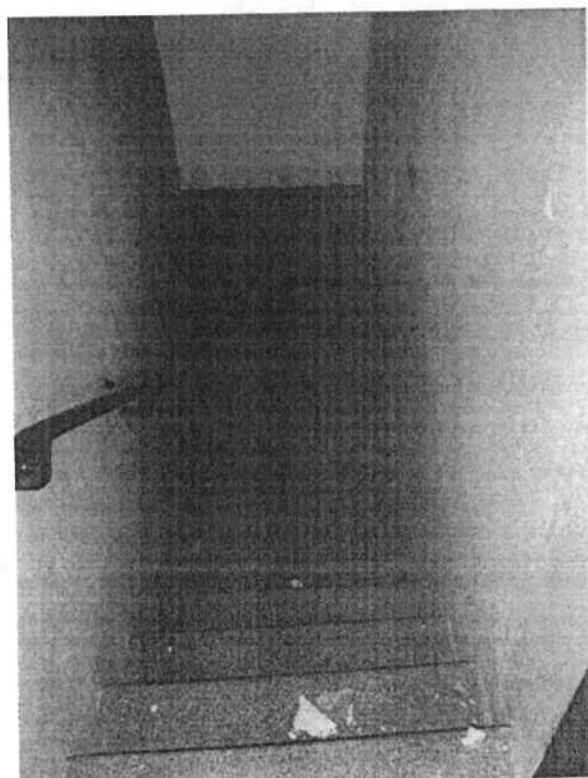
Scala che porta dal piano terra al piano primo.
